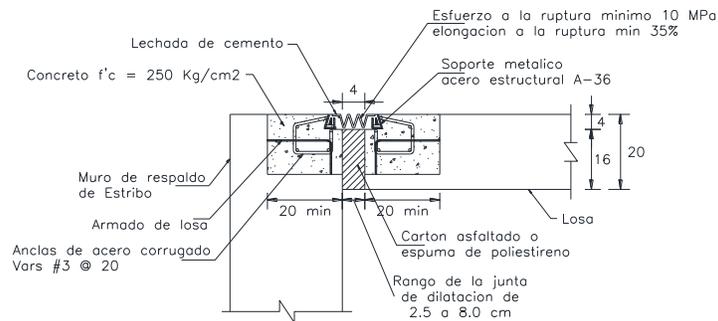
Detalle de junta de calzada tipo MEX-T-50 en caballete.
